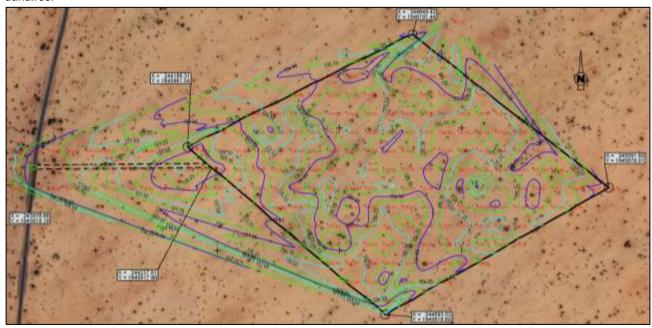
Plan des courbes de niveau du CET Kiffa et sa route d'accès18
